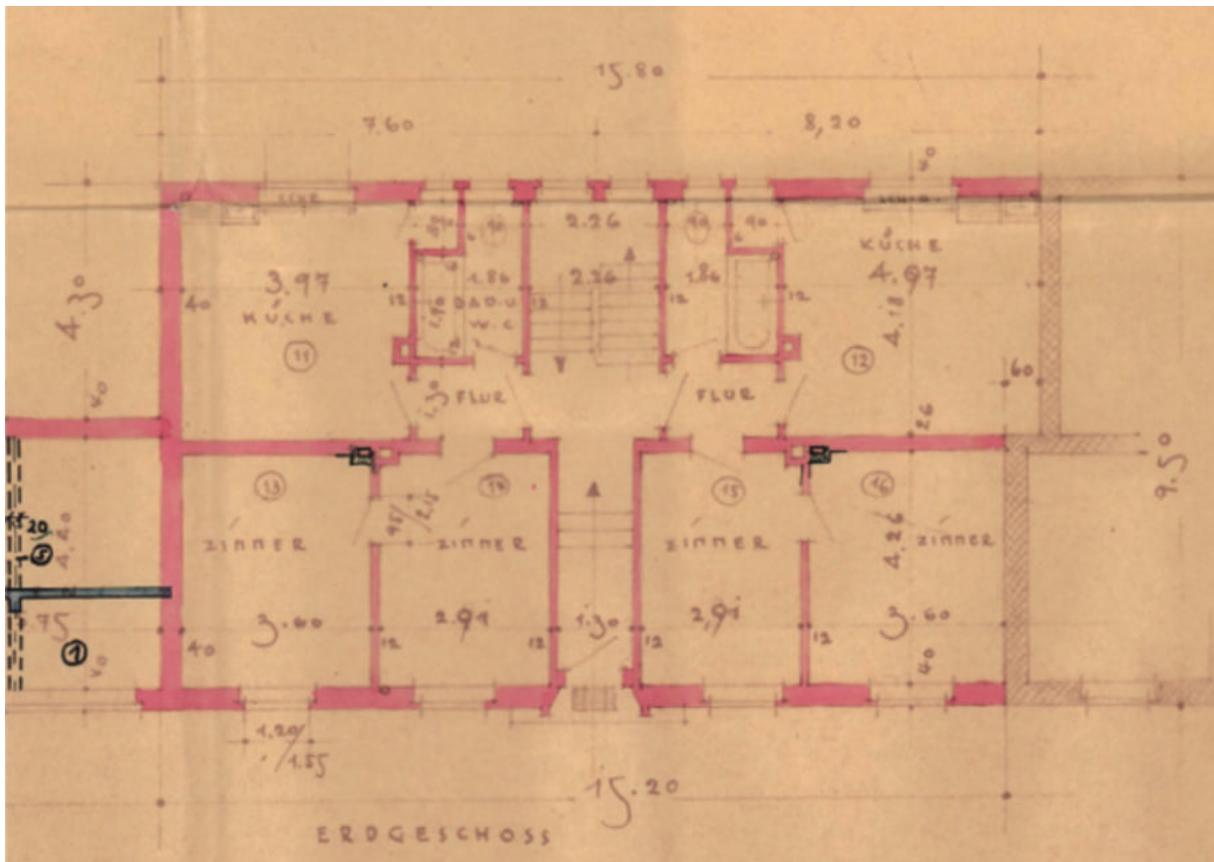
Beispielhafter Gebäudegrundriss (Quelle: Stadt Remscheid)
